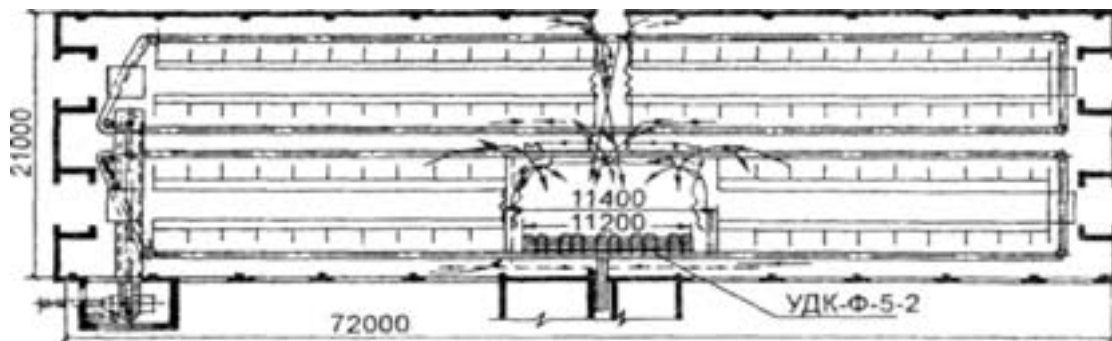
План реконструированного коровника с доильной установкой УДК-Ф-5-2.
